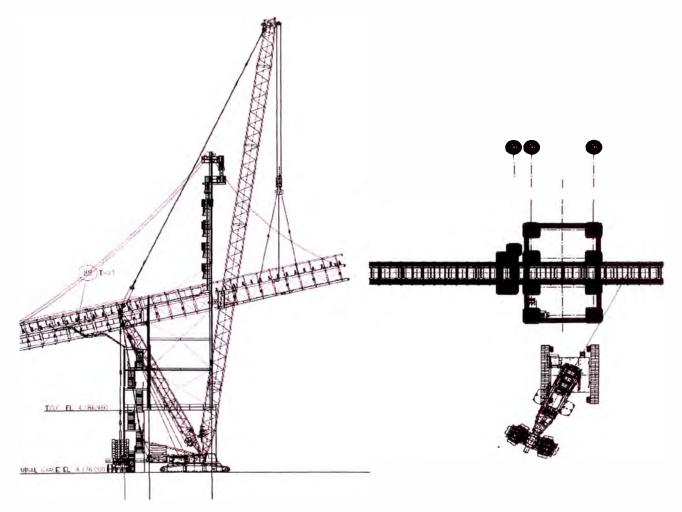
Ubicación de grúa LR 1400-2 montaje de secciones 1&2
